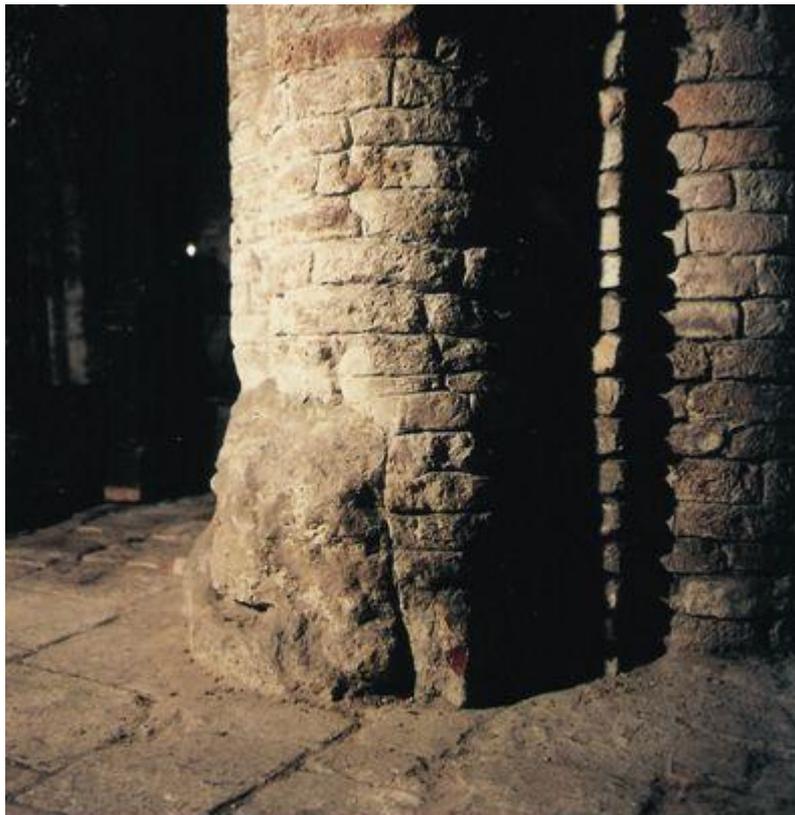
Il masso in arenaria inglobato alla base del pilastro polilobato (il 3 in fig. 7). Questo masso di notevoli dimensioni, proveniente dalle cave un tempo esistenti subito fuori Porta Castiglione, era già qui quando venne fabbricato il pilastro. Il costruttore dovette fare un notevole lavoro per adattare i laterizi mistilinei a questa struttura : è indubbio che sarebbe stato molto più semplice distruggerlo a martellate e innalzare il pilastro, come fu fatto per gli altri, direttamente sulla base che qui manca. L'unica spiegazione logica è che, quando si convenne di salvarlo con notevole
